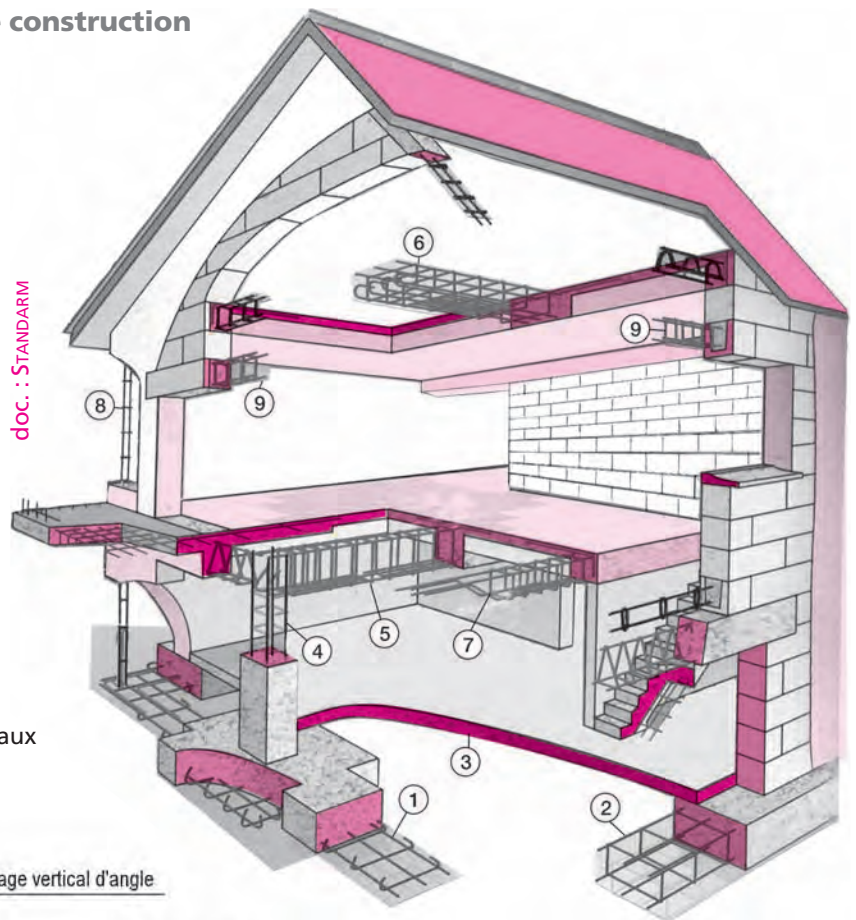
Ouvrages en béton armé associés aux maçonneries de mur
